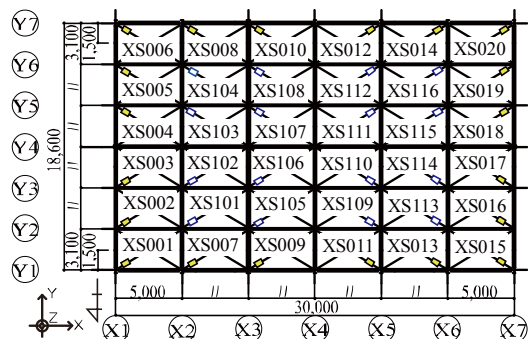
屋根ブレース材のひずみ計の計測位置 (単位: mm)
